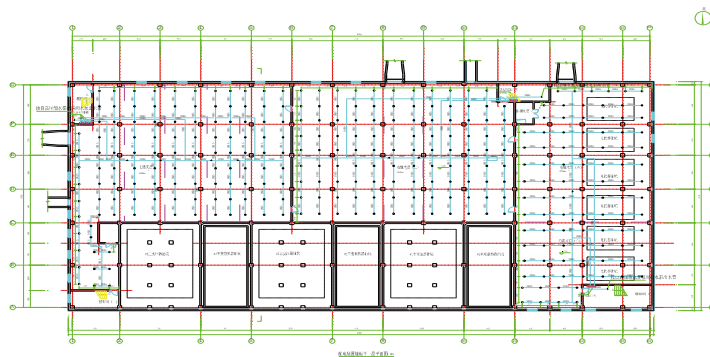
TJ-220-A2-4 方案电缆夹层高压细水雾平面布置图
